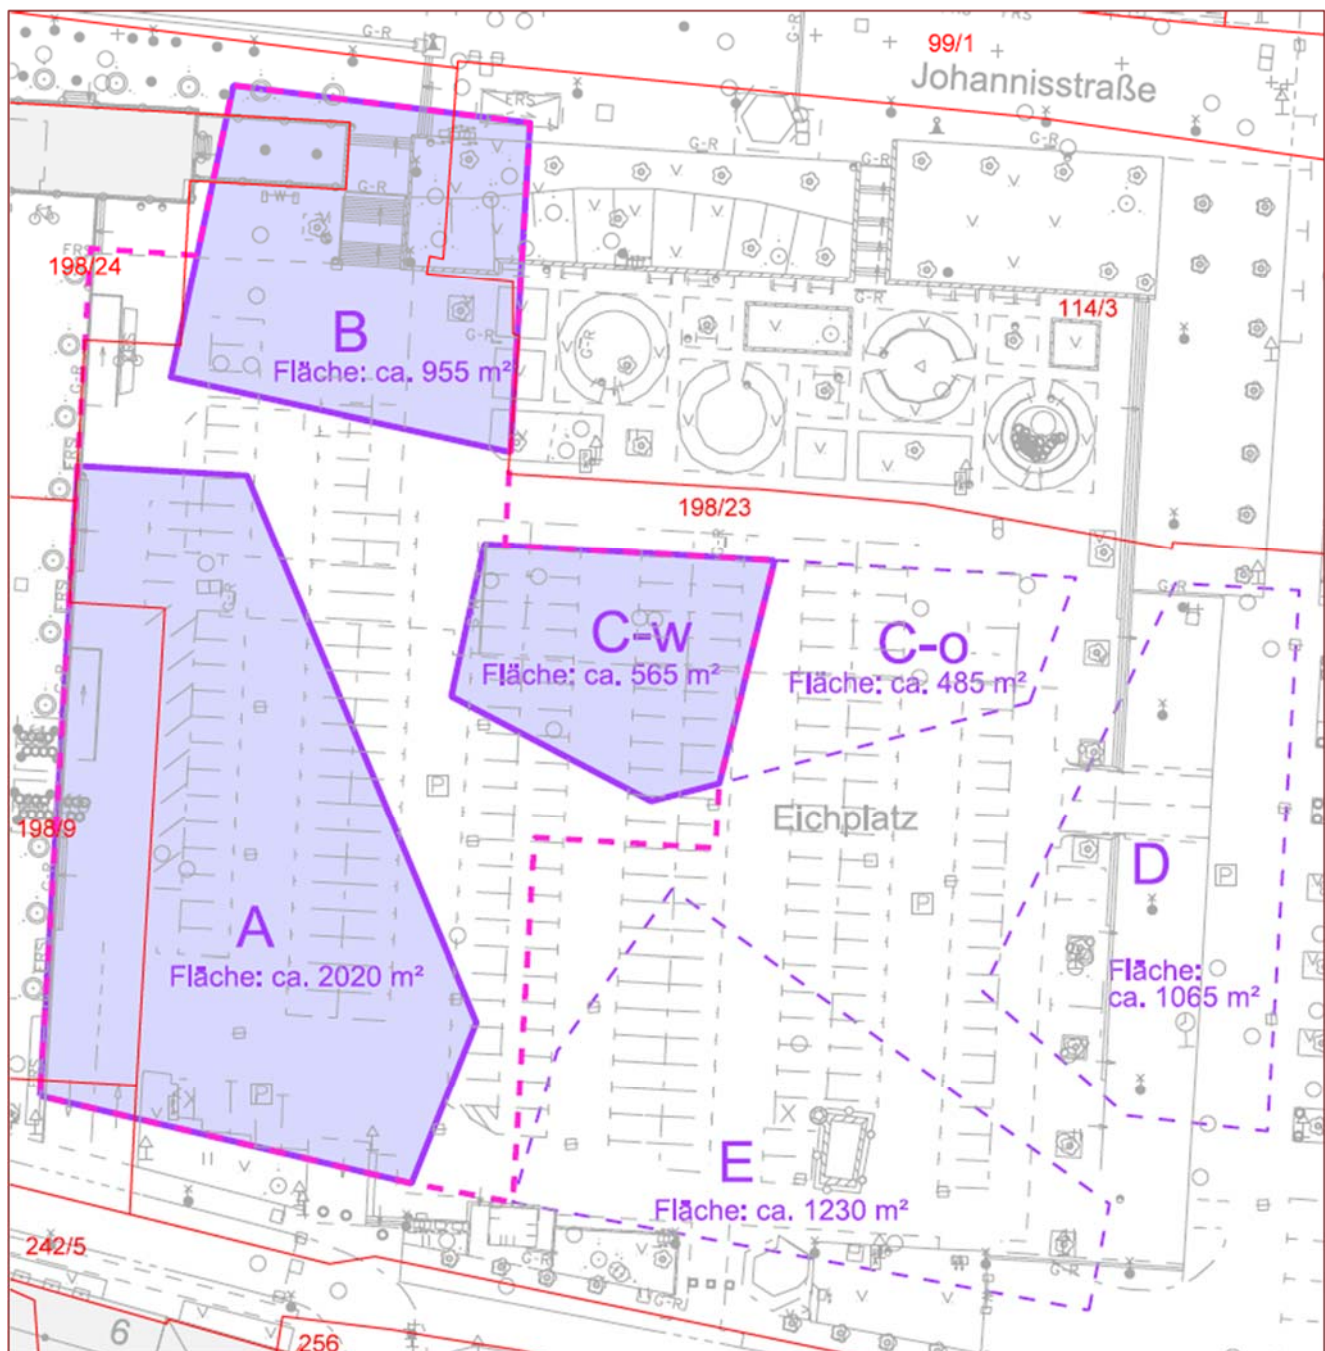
Darstellung der Bauflächen der Gebäude auf dem Baufeld A, Quelle: Stadt Jena
